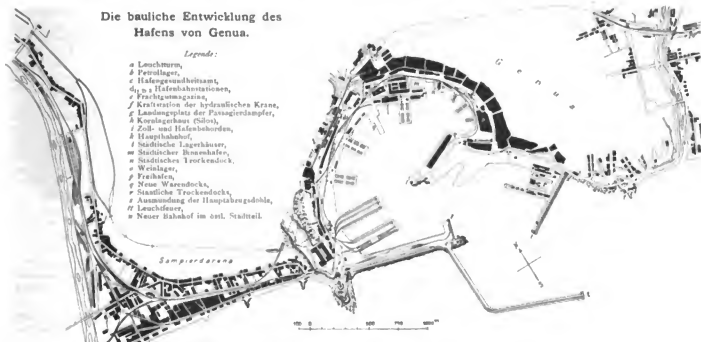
Lageplan des Hafens im Jahre 1904. — Massstab 1 : 30 000.
